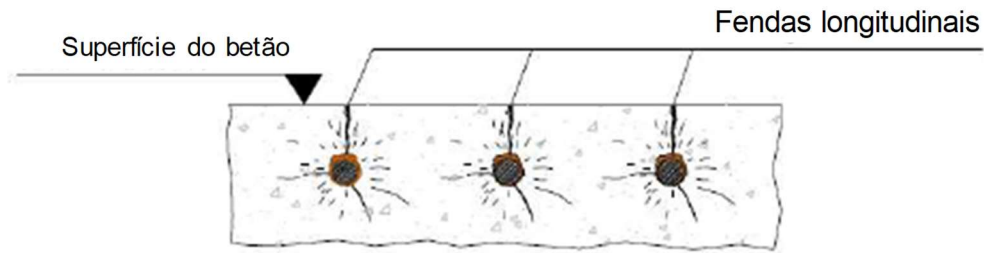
Fissuras longitudinais no betão, geradas pelos óxidos de ferro. (Adaptado de (Pina, 2009))
